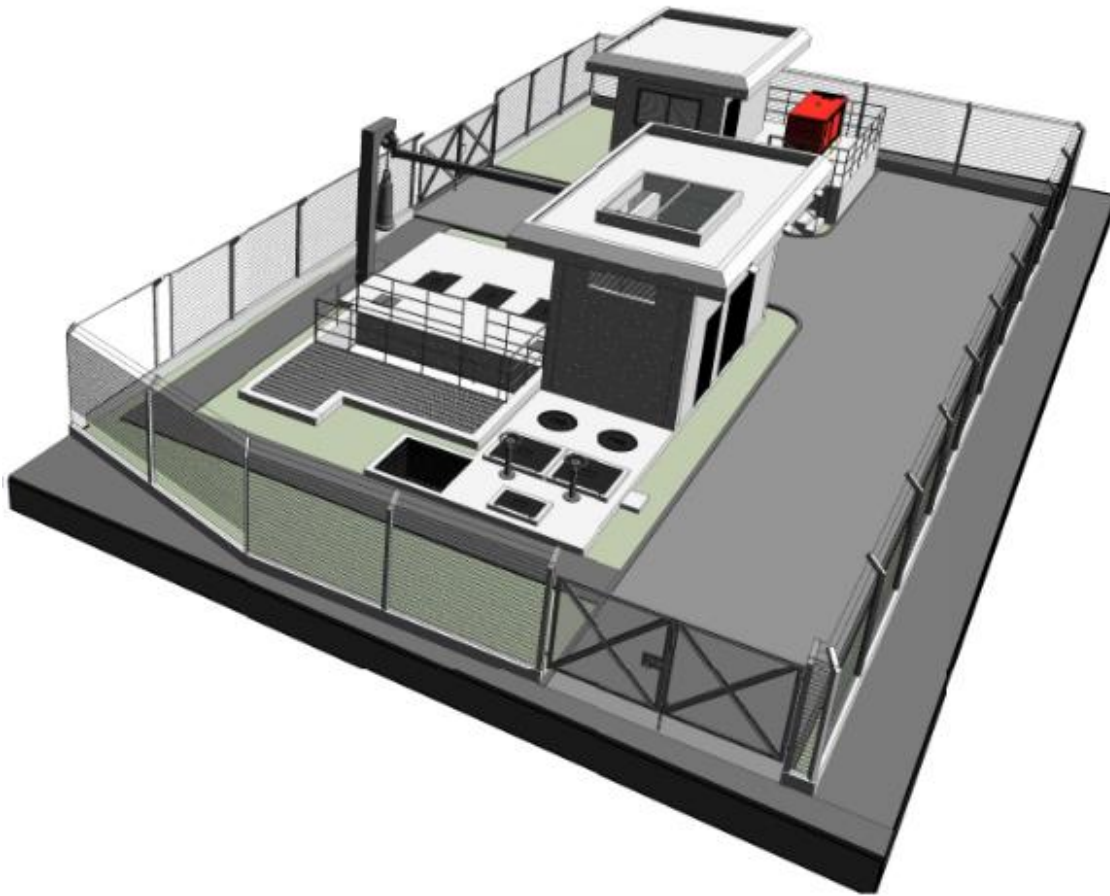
Modelo de elevatória – poço com gradeamento, sucção e barrilete
